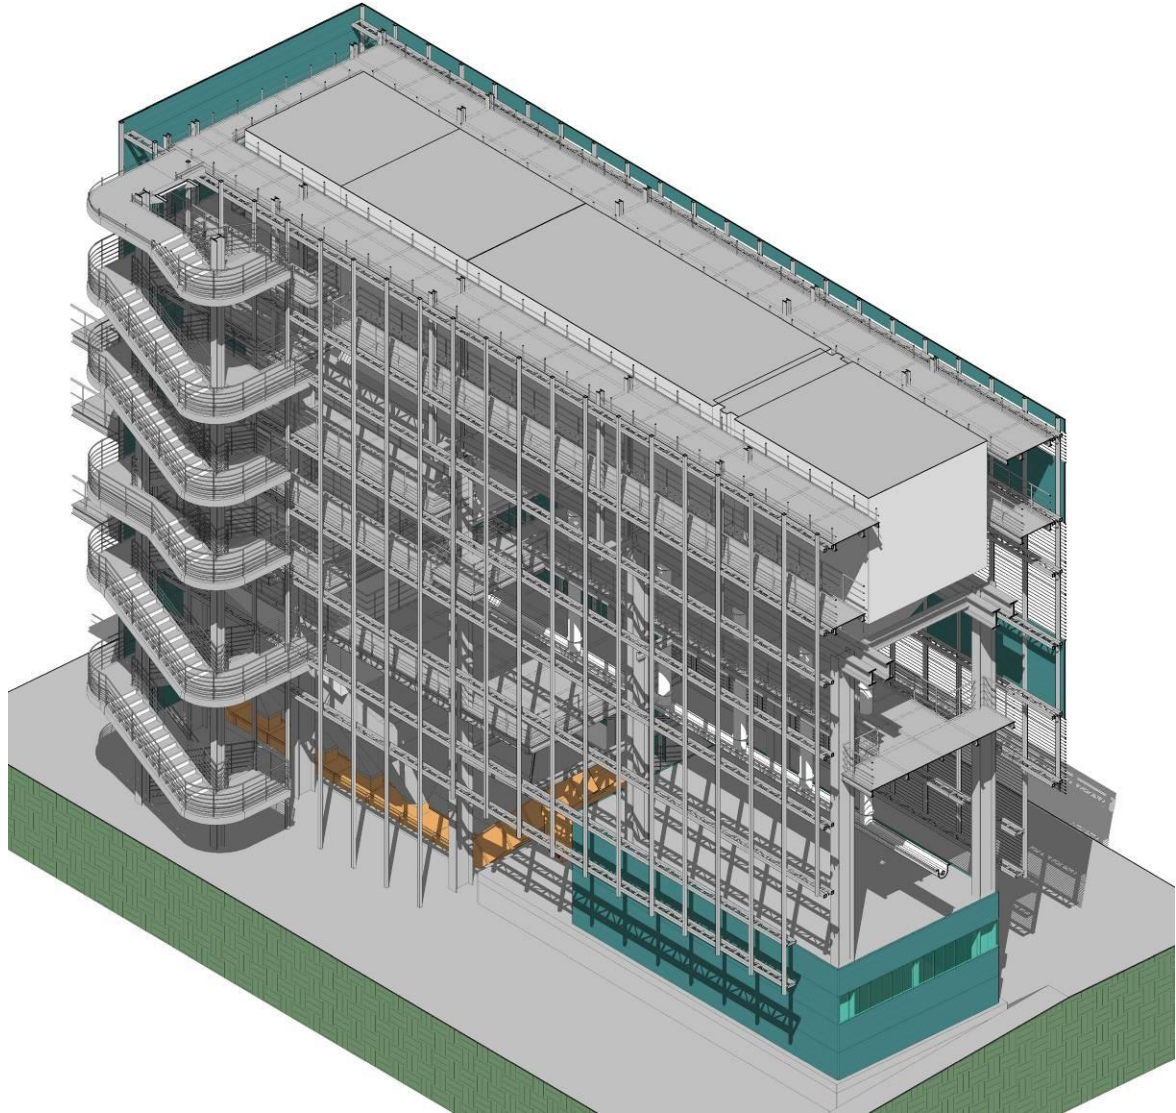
Vista dello spaccato generale del sistema scale-ballatoi all'interno dei tamponamenti di chiusura.
